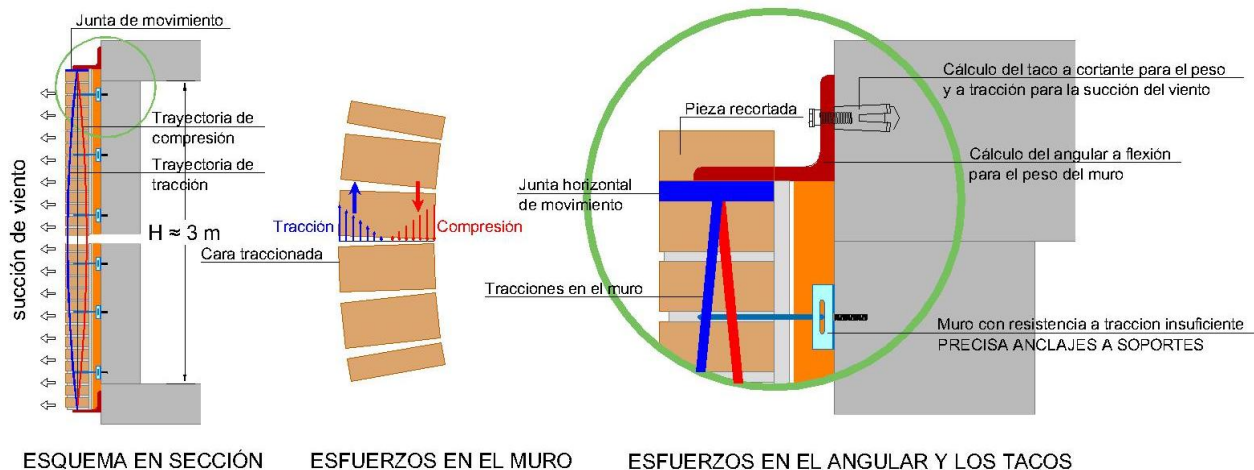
Fachada con junta horizontal de movimiento (*sistema alternativo a la fachada confinada*)
